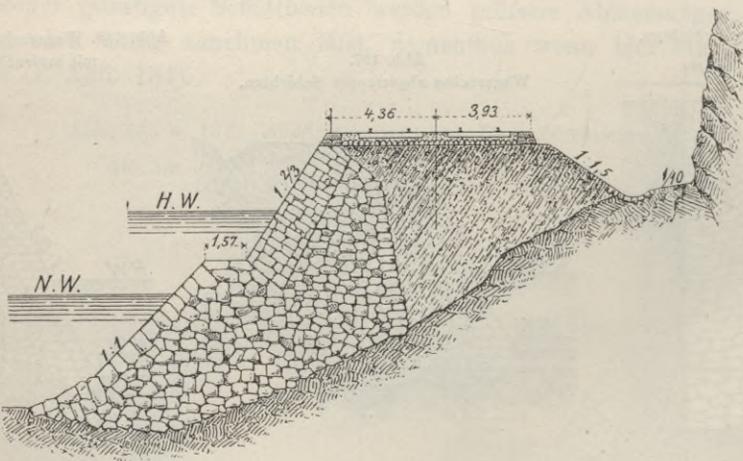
Sicherung der Dämme an der Brenner-Bahn bei Wasserangriff. M. 1 : 300.
